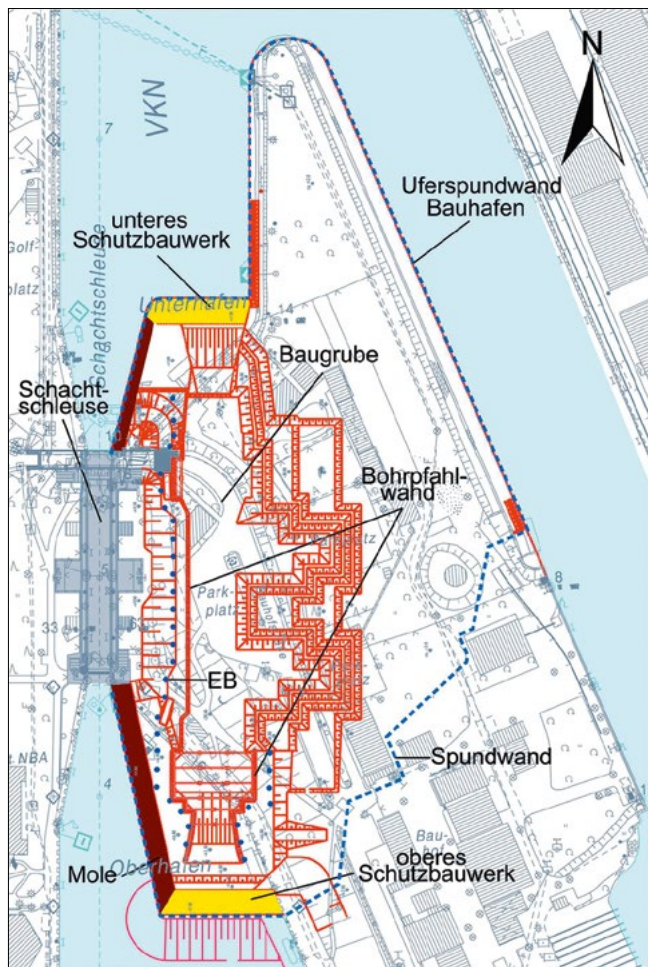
Lageplan der Baugrube mit Baugrubenumschließung (Quelle: NBA Hannover)
